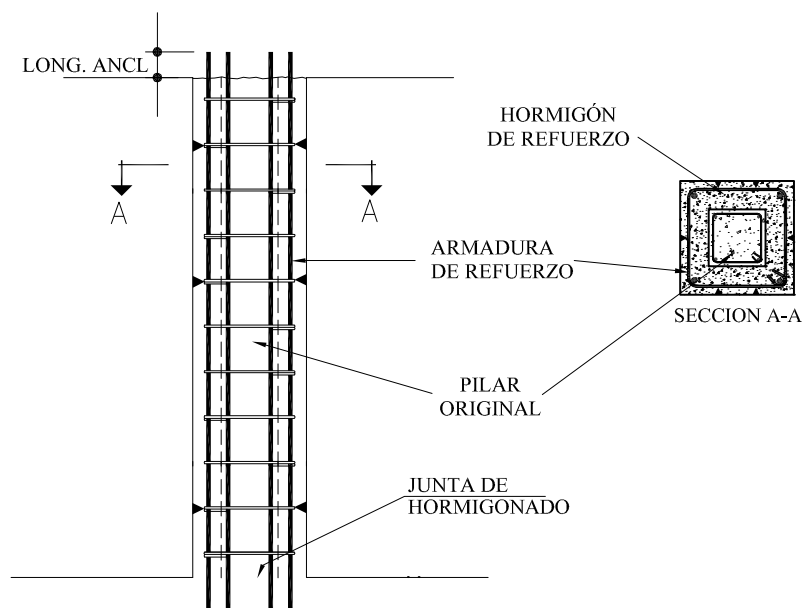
Esquema de refuerzo con encamisado de hormigón armado y armaduras ancladas a los forjados.
